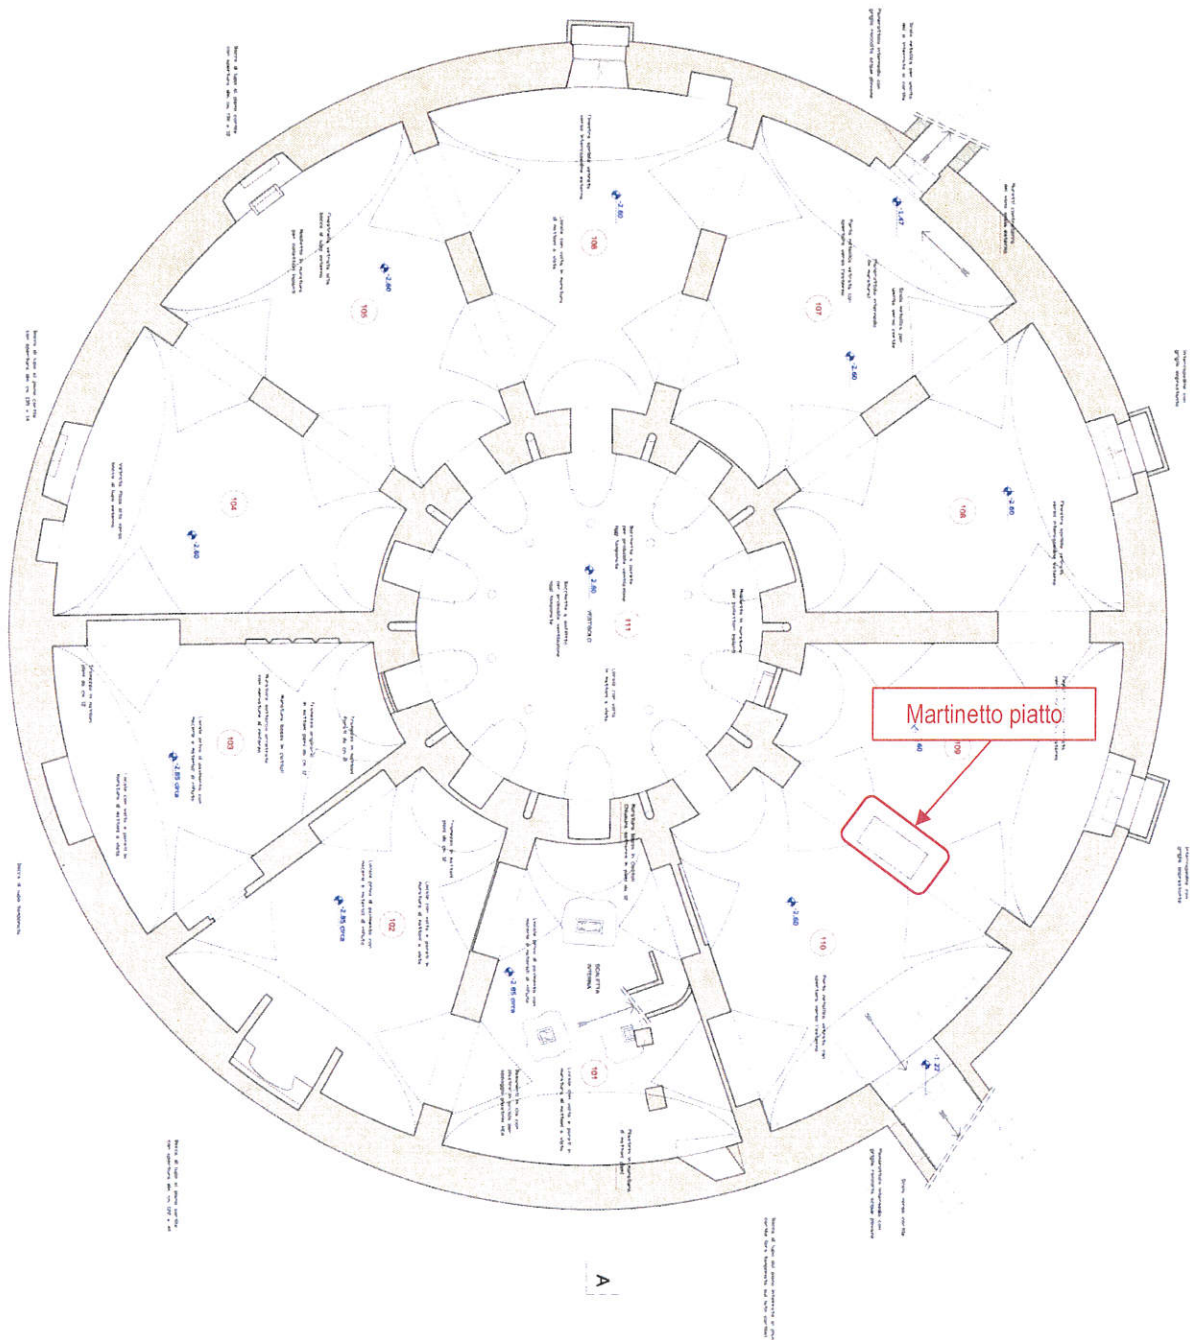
Piano interrato - posizione della prova con il martinetto piatto
